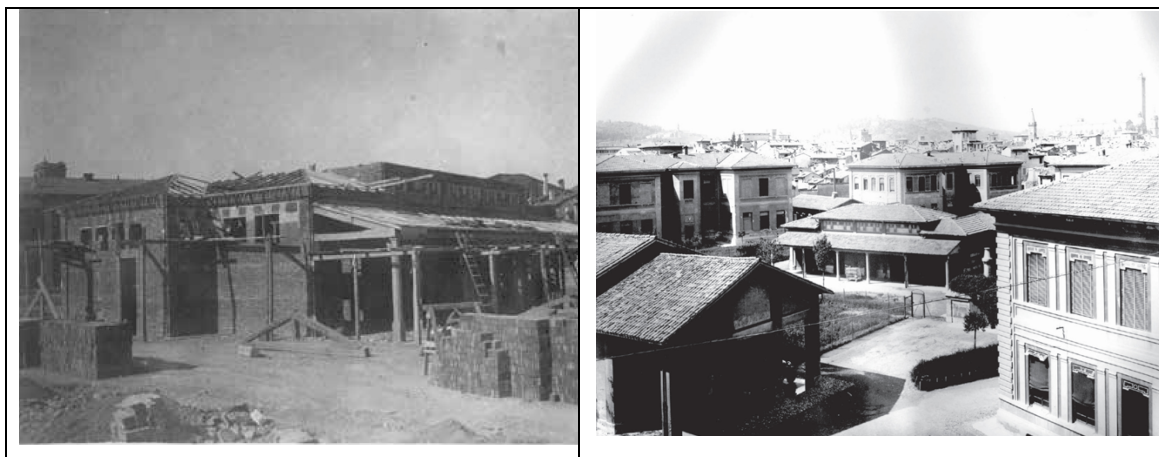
Foto storiche da archivio: a sinistra in fase di costruzione a destra ad edificio ultimato
